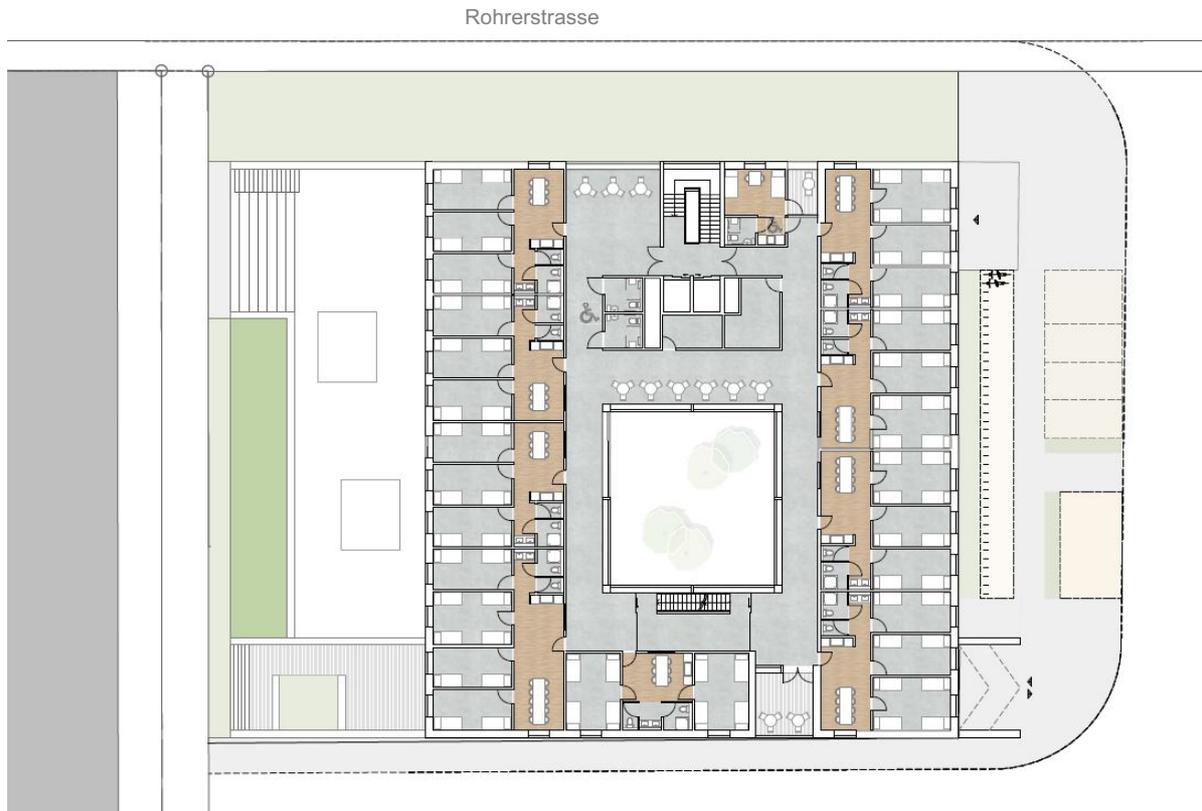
Auszug aus Machbarkeitsstudie Walker Architekten AG, Grundriss OG1 – OG4 (Regelgeschoss), Stand 31. Mai 2021
